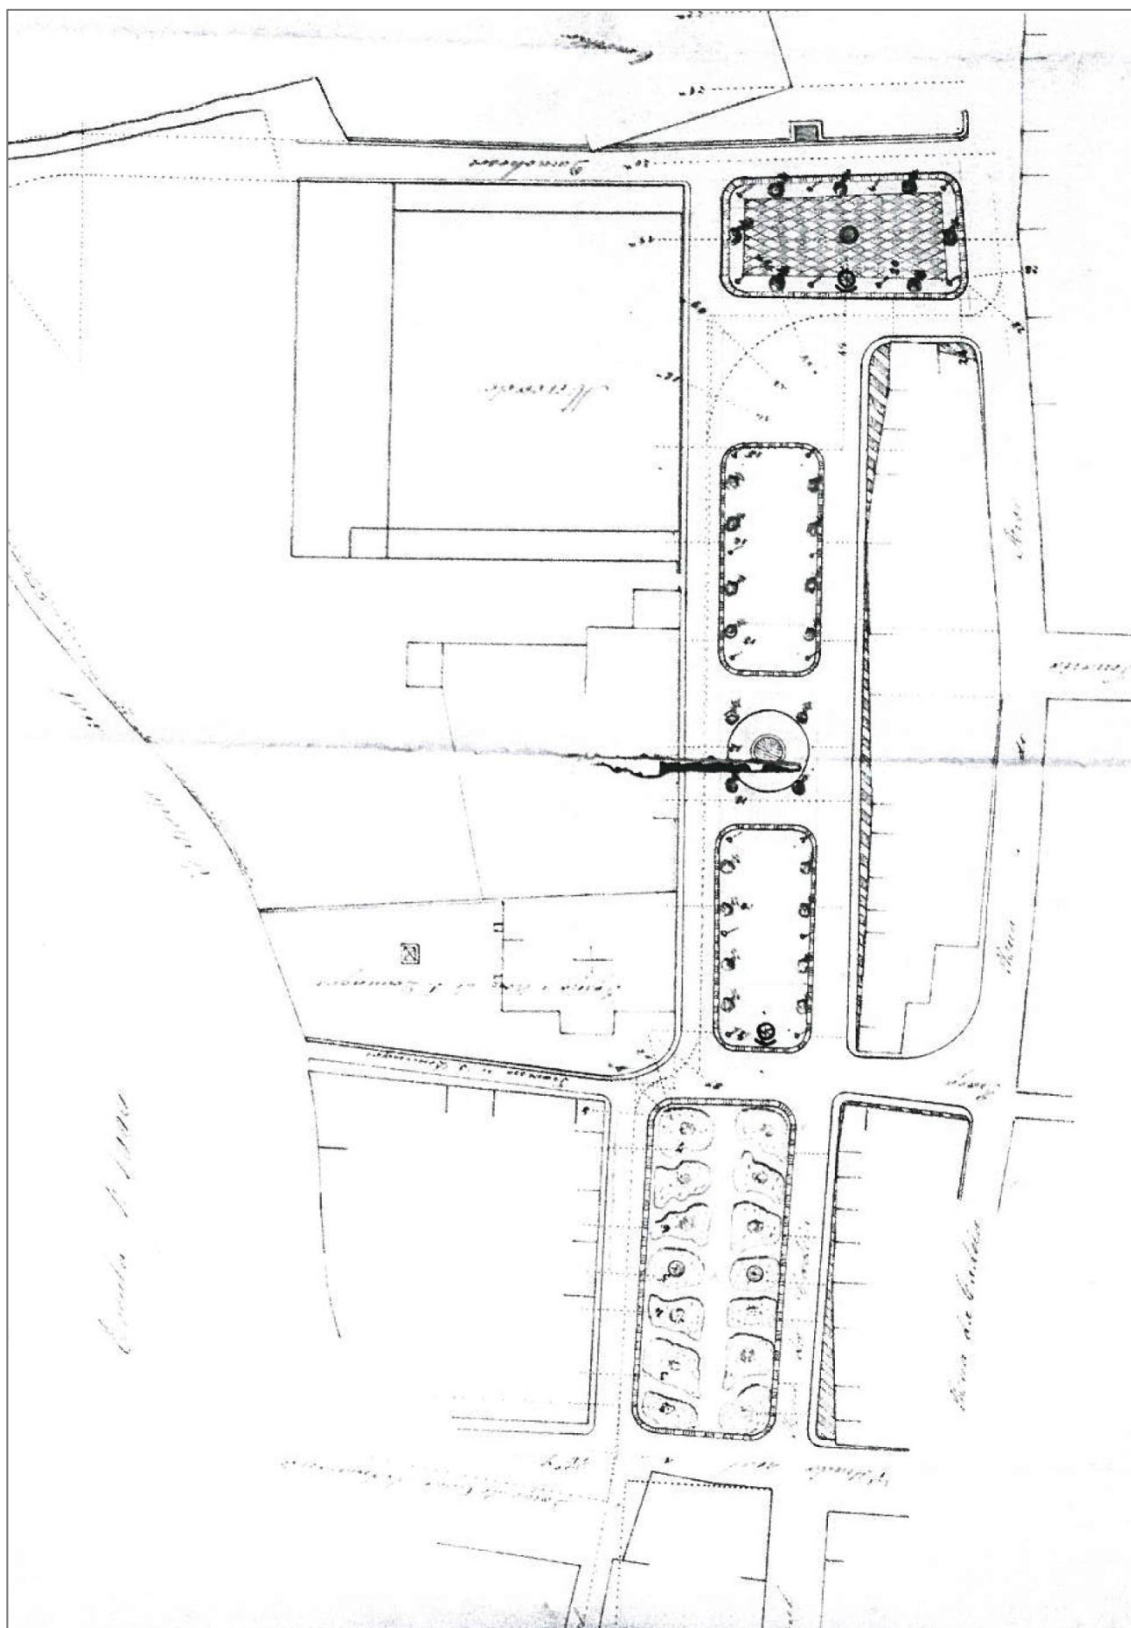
Planta da remodelação das Praças Luís de Camões e Lopo Vaz (189-)
